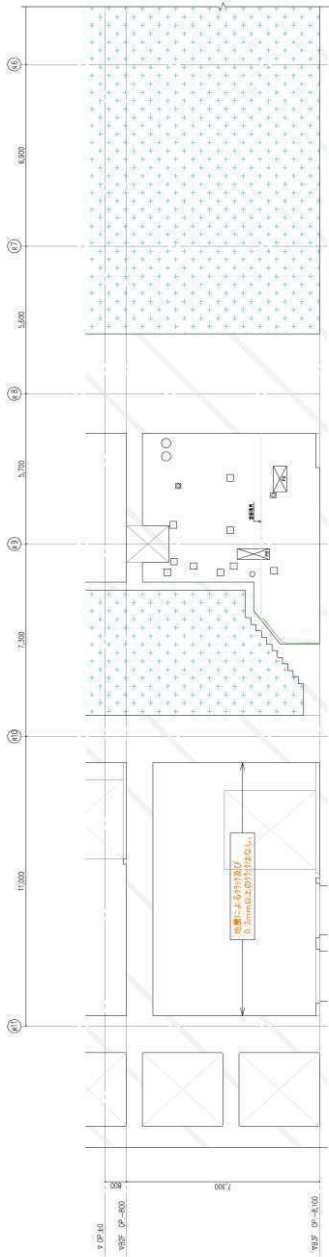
原子炉建屋のひび割れ分布 耐震壁 (6) 地下3階 RC 通り
